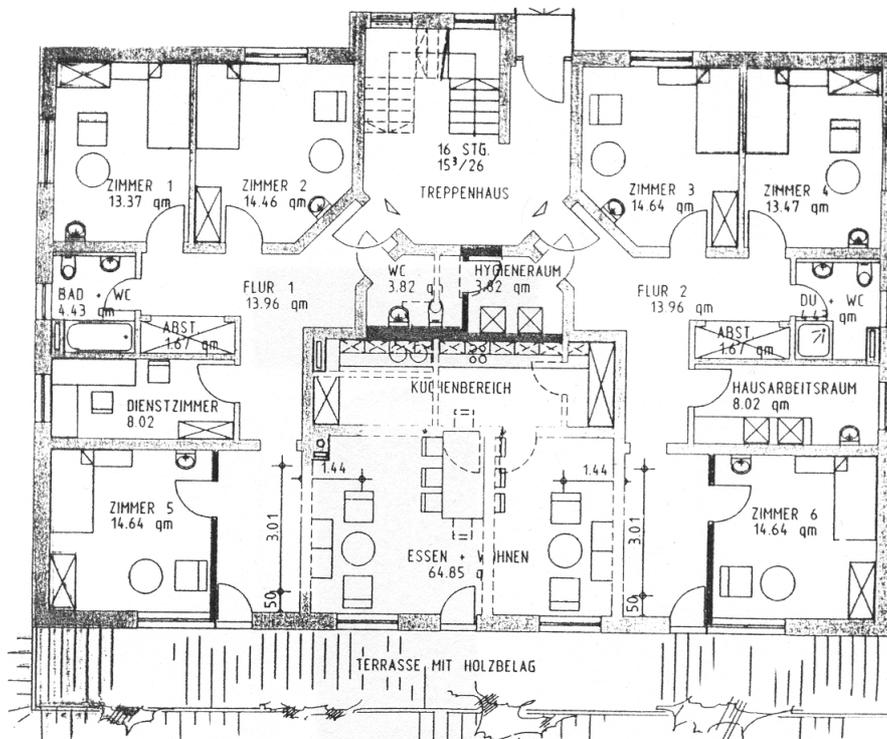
Grundrisszeichnung Hausgemeinschaft / Wetter
